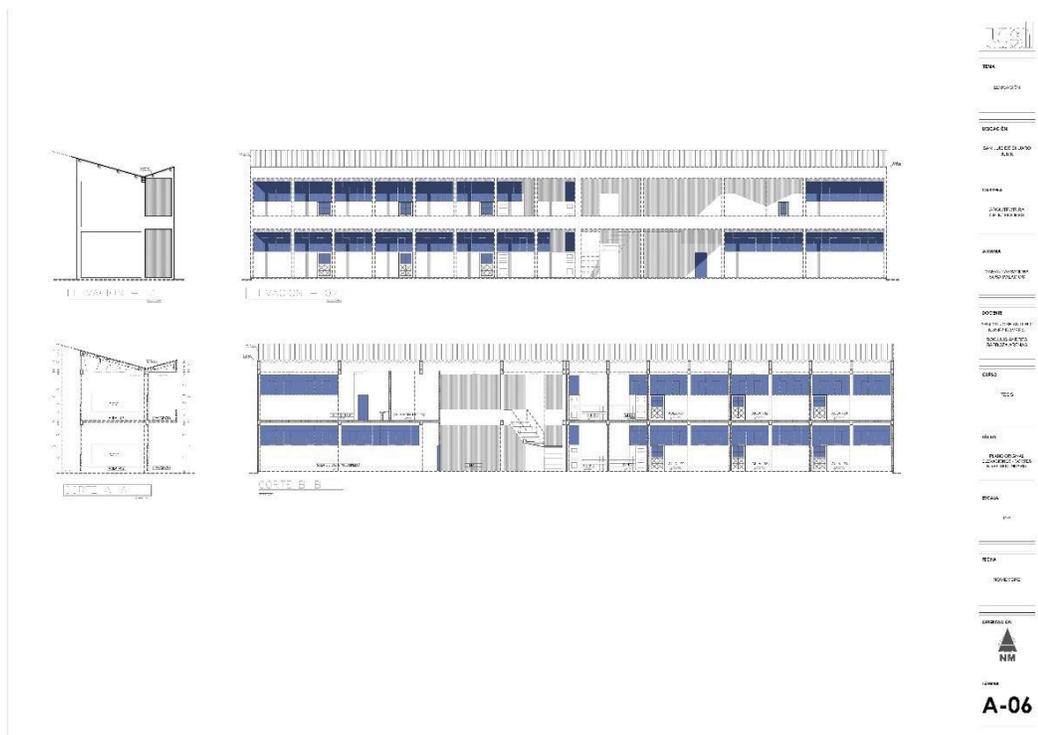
Planimetría Existente de la Municipalidad de San Luis de Shuaro. *Fuente:* Maeva Sosa
